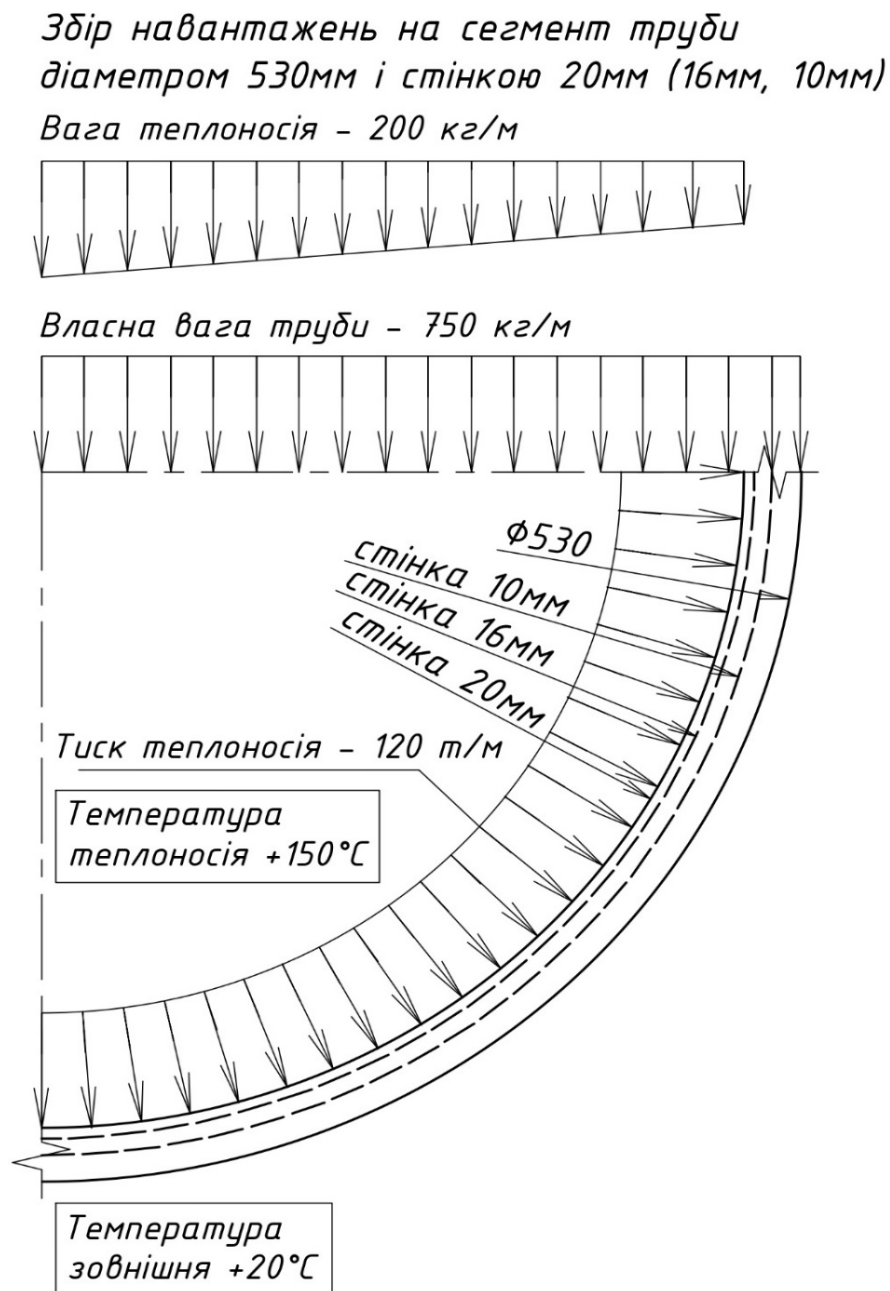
Розрахункова схема трубопроводу з навантаженнями
